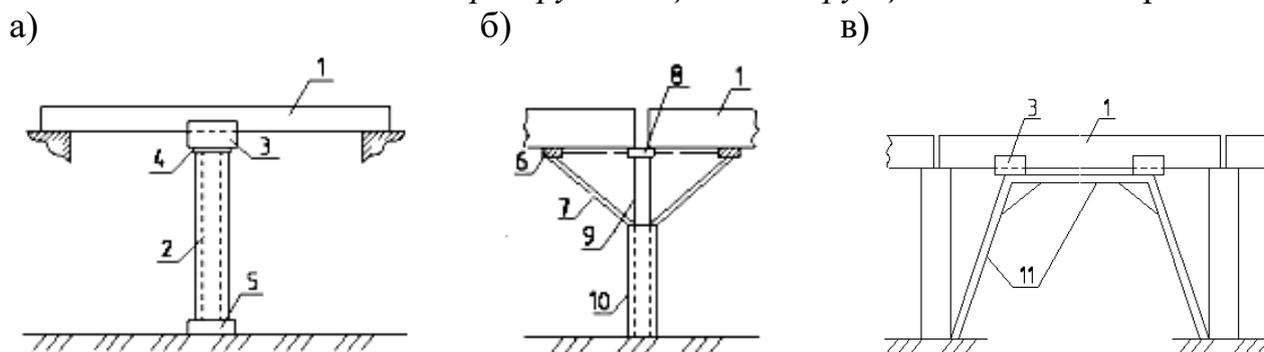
Схема усиления железобетонных балок подведением разгружающих конструкций: а) – разгружающих стоек; б) – подкосов; в) – порталных рам; 1 – усиливаемая конструкция; 2 – разгружающая стойка; 3 – опорный элемент из швеллера или уголка; 4 – стальные клинья для включения усиливаемой конструкции в работу; 5 – база стойки; 6 – металлические прокладки на графитовой смазке; 7 – стальные подкосы; 8 – затяжка с талрепом; 9 – существующая колонна; 10 – обойма, устраиваемая на существующей колонне; 11 – дополнительные опоры в виде порталных рам
